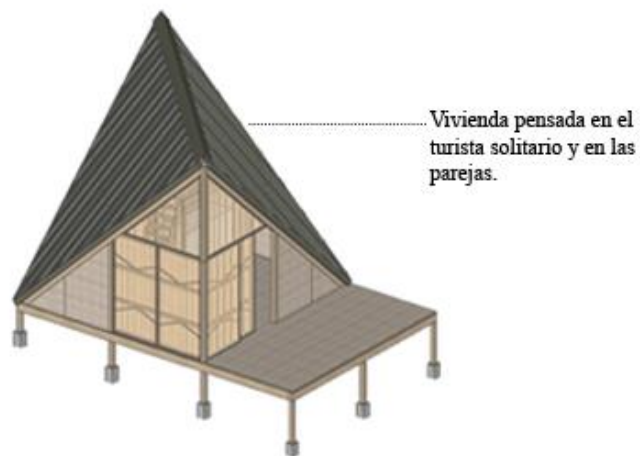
Materialidad y sistema constructivo de la vivienda temporal individual.
